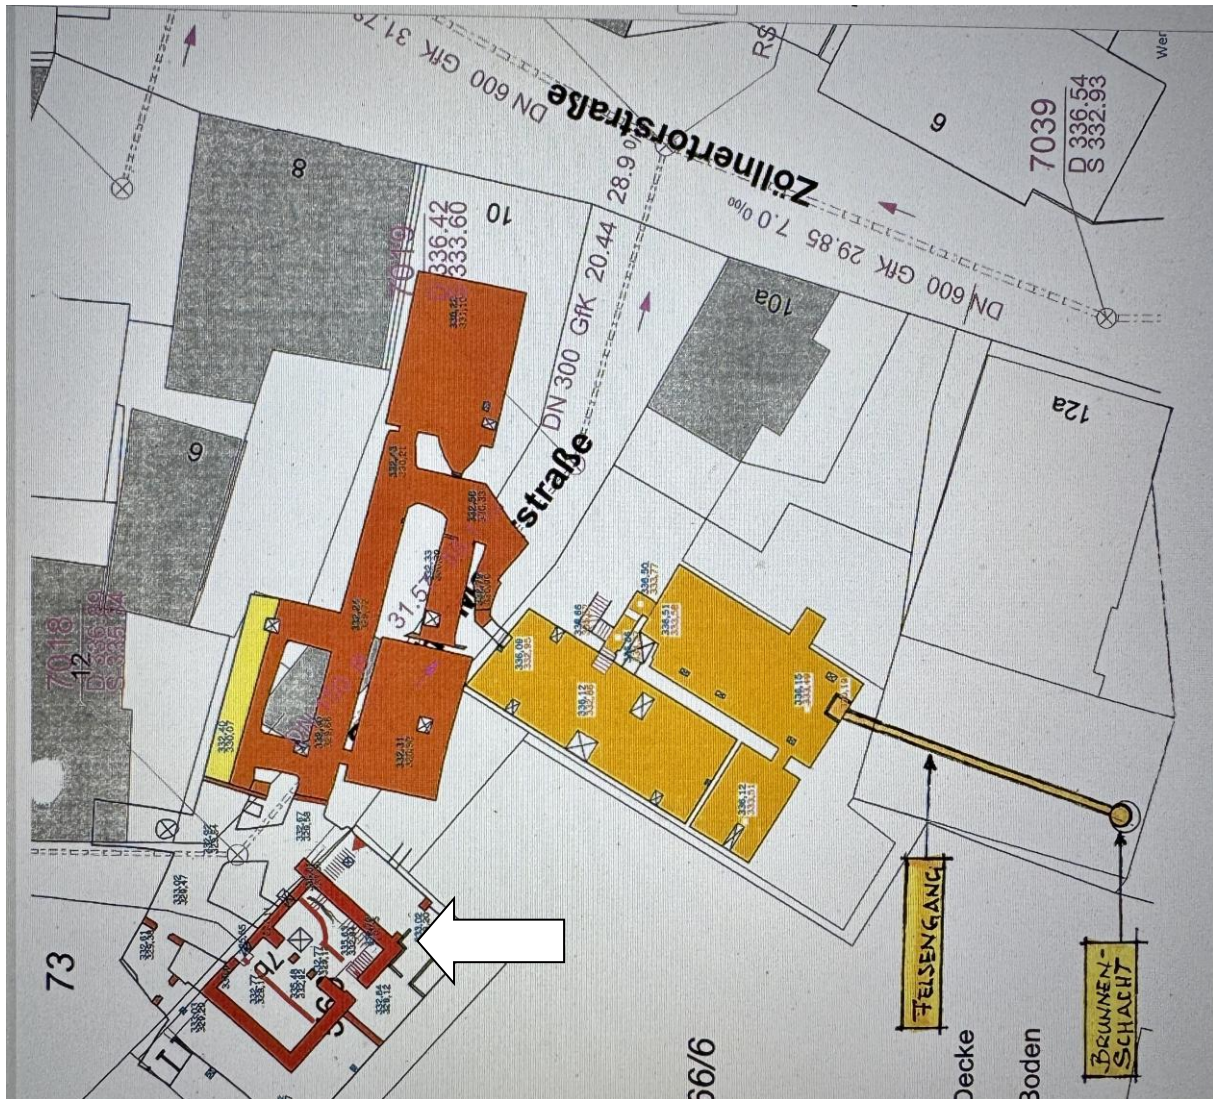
Lageplan mit der untersuchten Kelleranlage (Pfeil)
